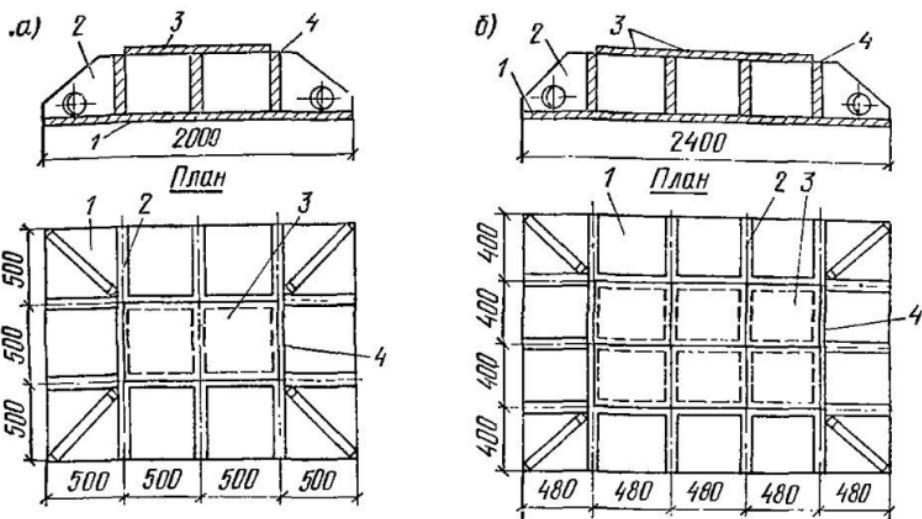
Опорные башмаки сварной конструкции
